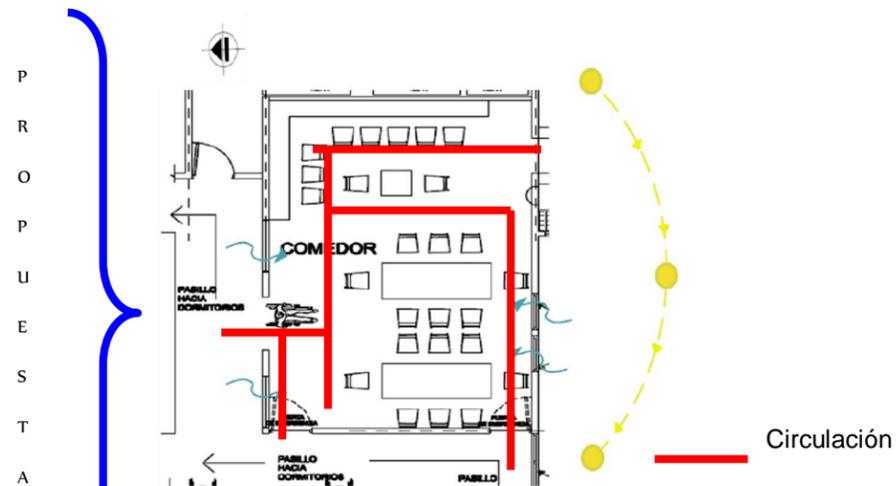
Planta de análisis, comedor propuesta./ Fuente: Propia
